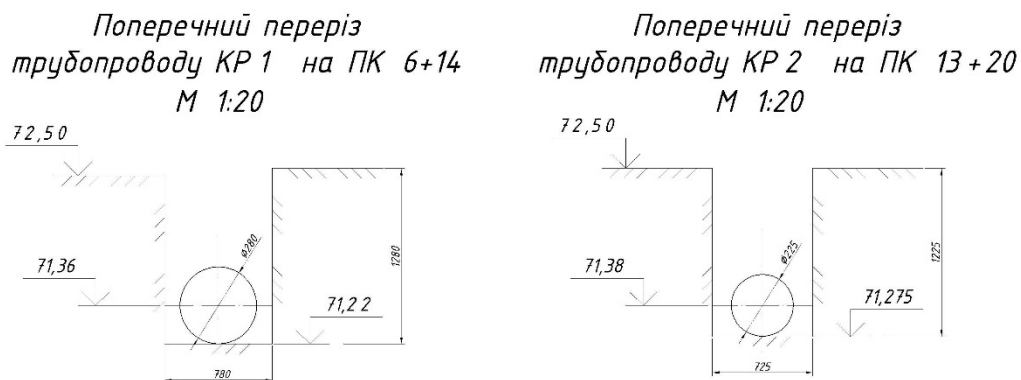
Поперечні перерізи зрошувальних трубопроводів
